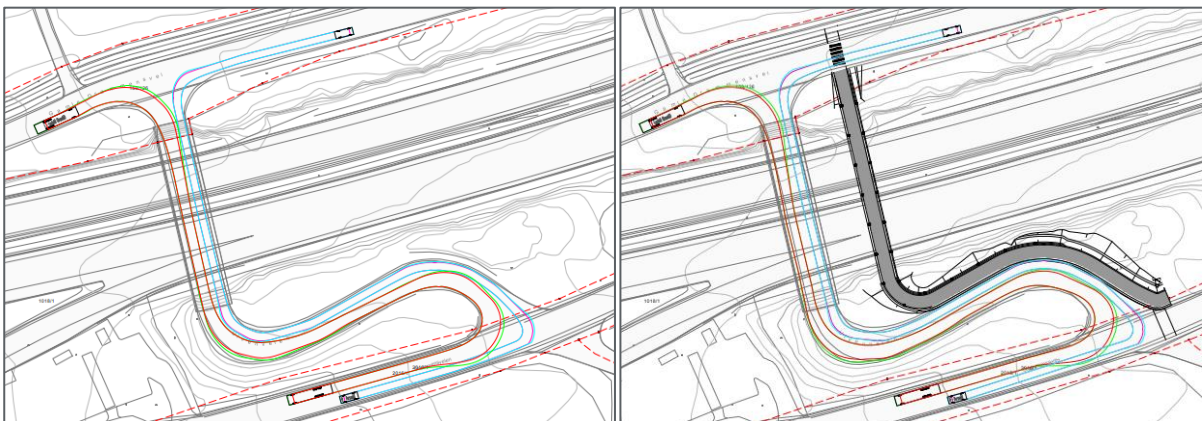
Sporing lastebil. Venstre: eksisterende situasjon. Høyre: ny situasjon
